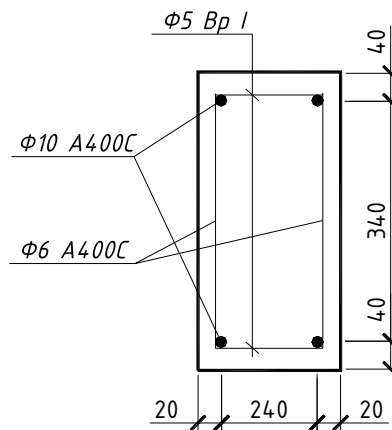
Арматування верхнього поясу гратчастої балки.
